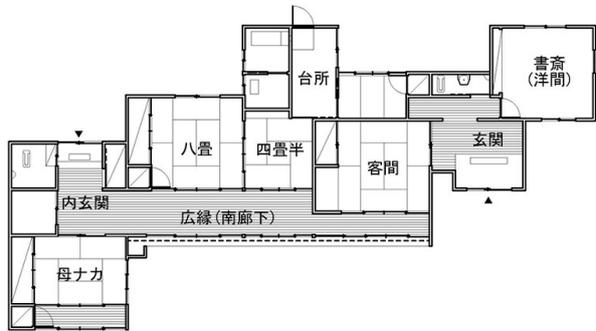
吉祥寺時代の家 推定復元平面図 (作成者：友田博通氏)
